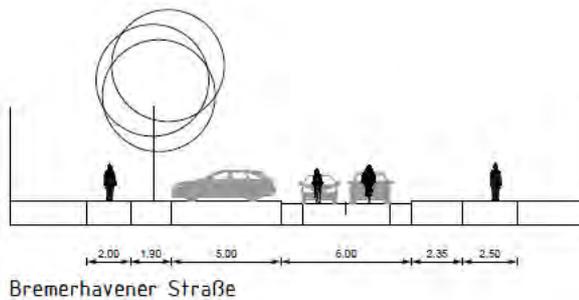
Querschnitt mit Fahrradstraße Bremerhavener Straße (Teil 1).
